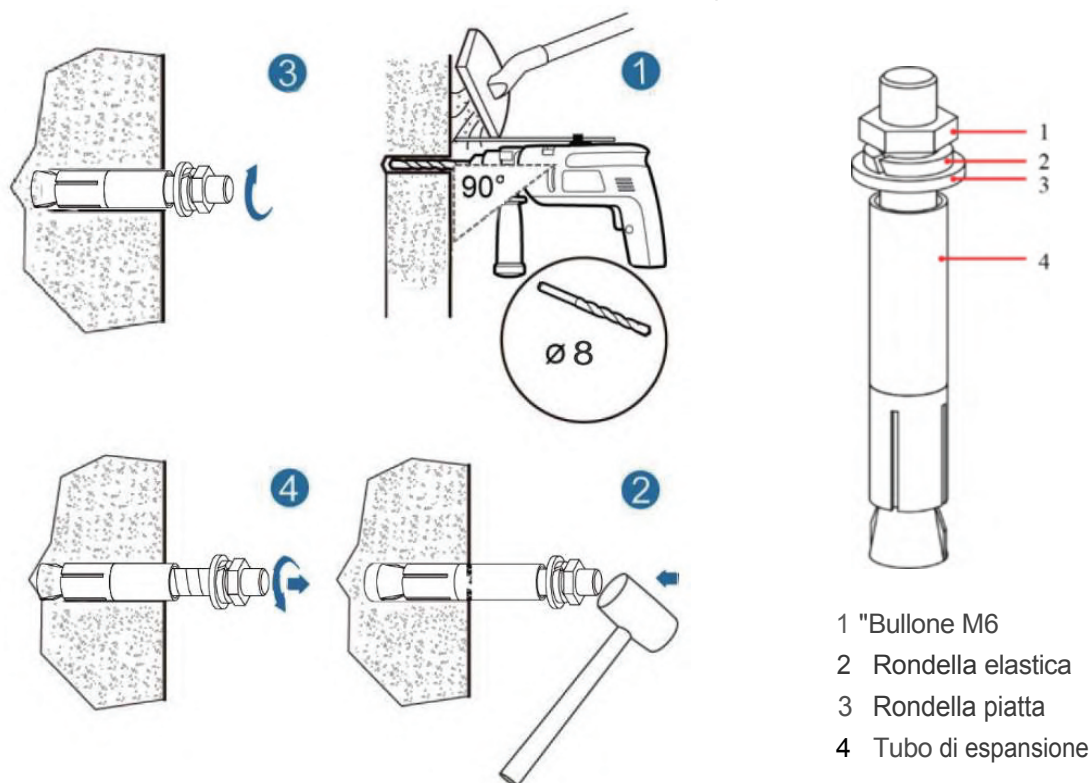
Installazione del bullone di espansione (unità: mm)
